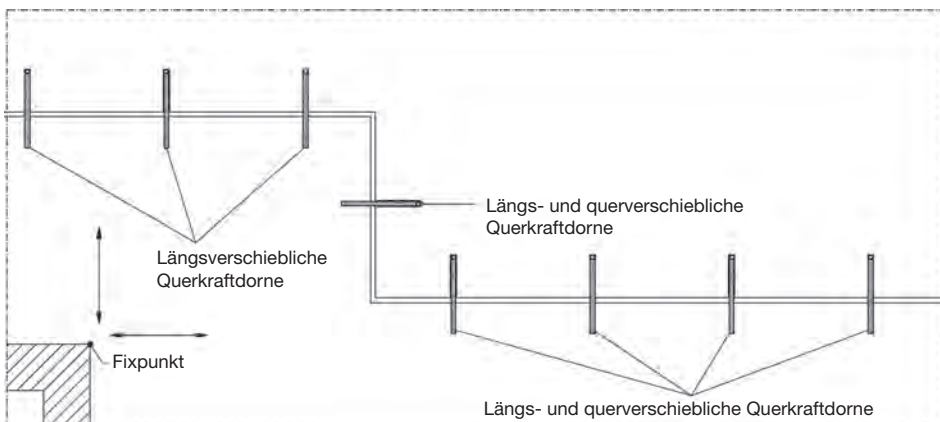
Grundriss einer nicht gerade verlaufenden Fuge
